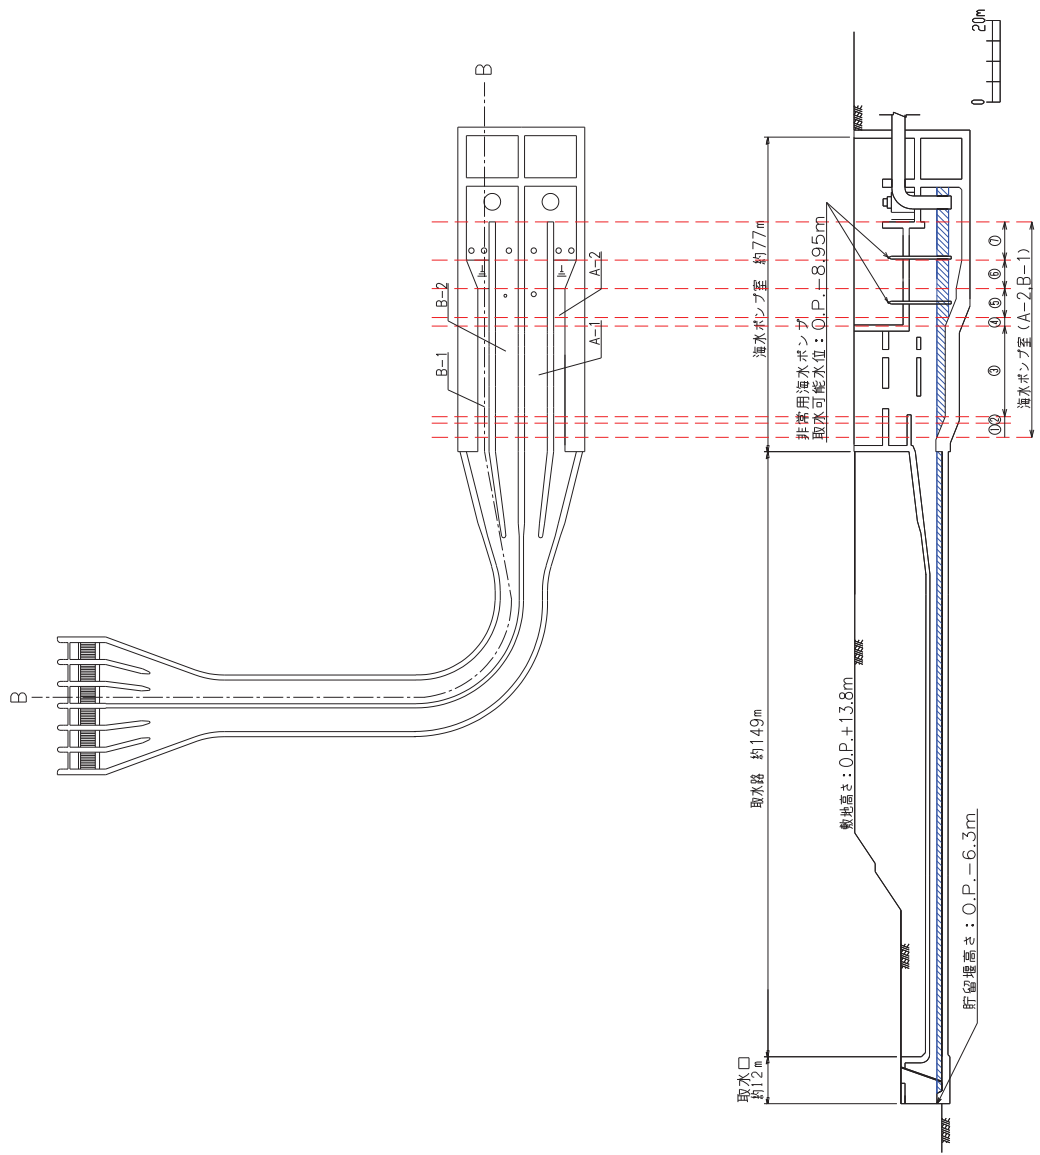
(3) 非常用取水設備の平面図及び縦断面図 (B-B) (海水ポンプ室 (A-2, B-1))
